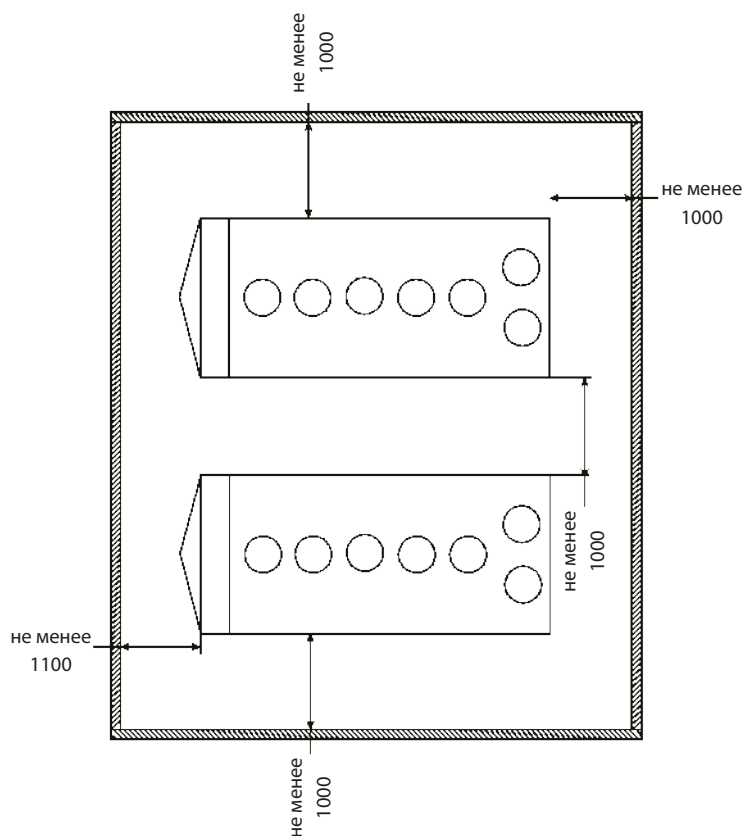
Схема установки нескольких чиллеров 760...1100
